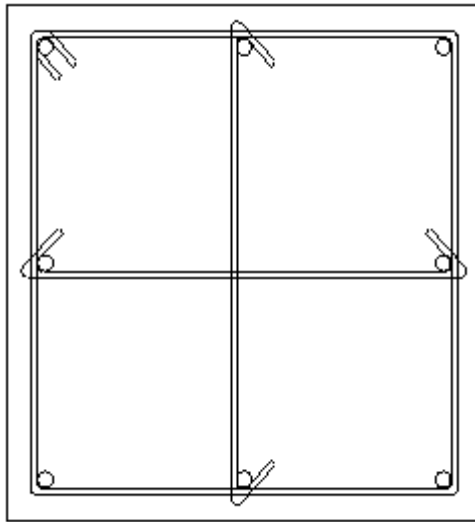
Detail Penulangan dan Jumlah Kaki Balok Lapangan (B1)
